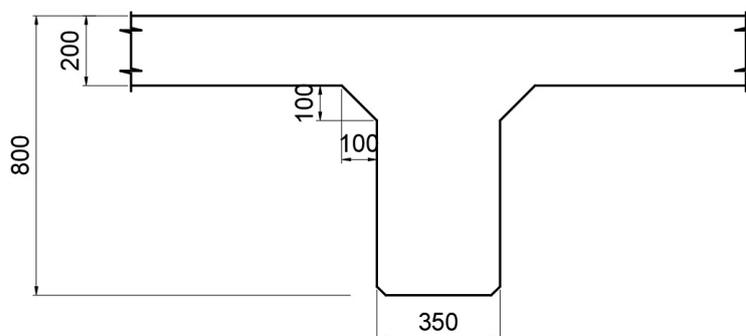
Dimensiones de la viga de H.A. [Elaboración propia]
